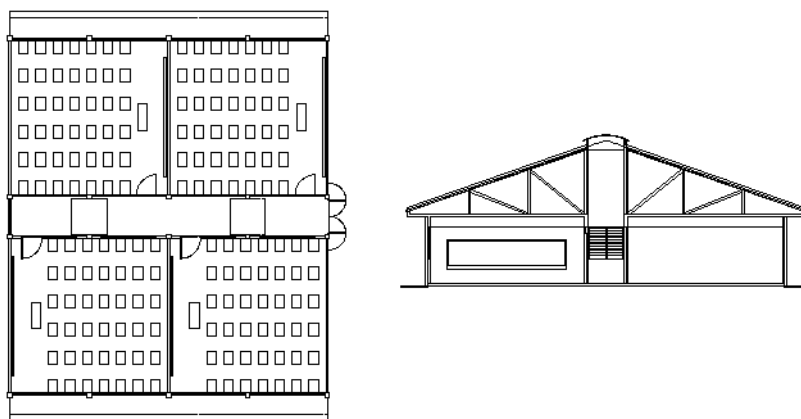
Planta e corte das salas de aula do projeto padrão 023
